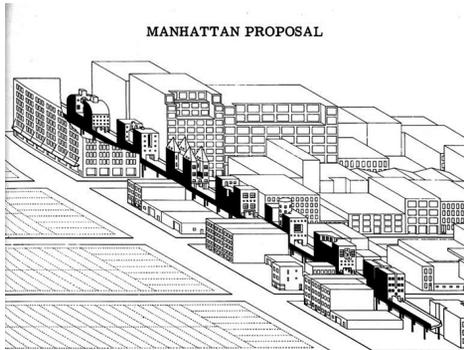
Propuesta para Manhattan de Steven Holl dentro del proyecto teórico “*Bridge of Houses*”, 1981.
